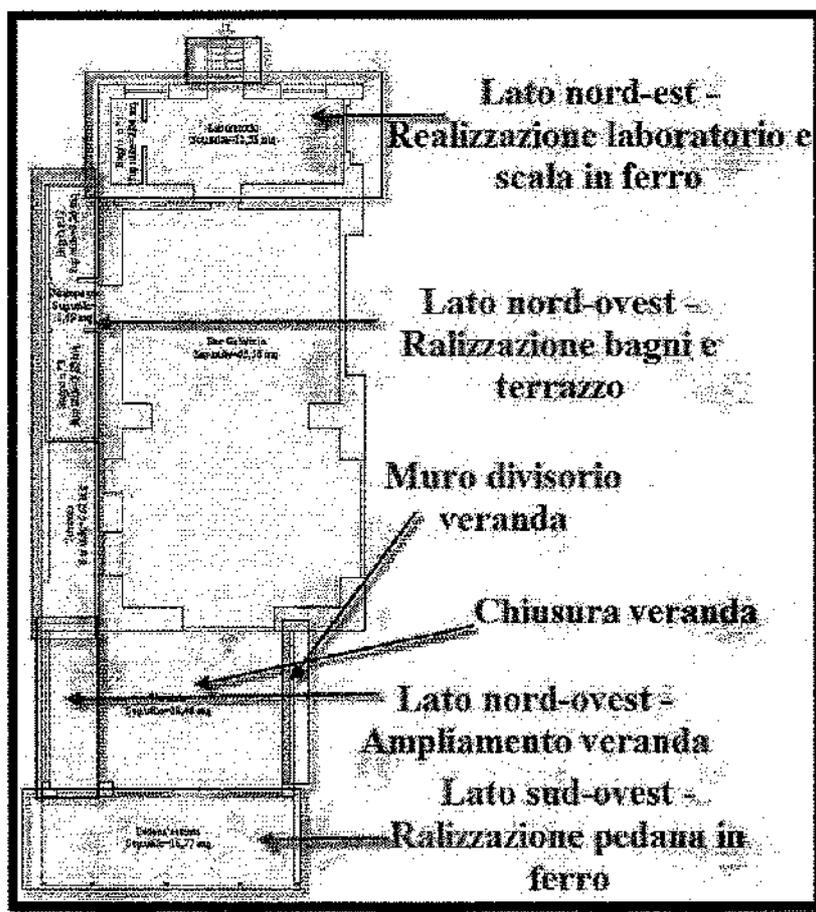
Pianta piano terra sub 1 - Rilievo eseguito in occasione dei sopralluoghi
